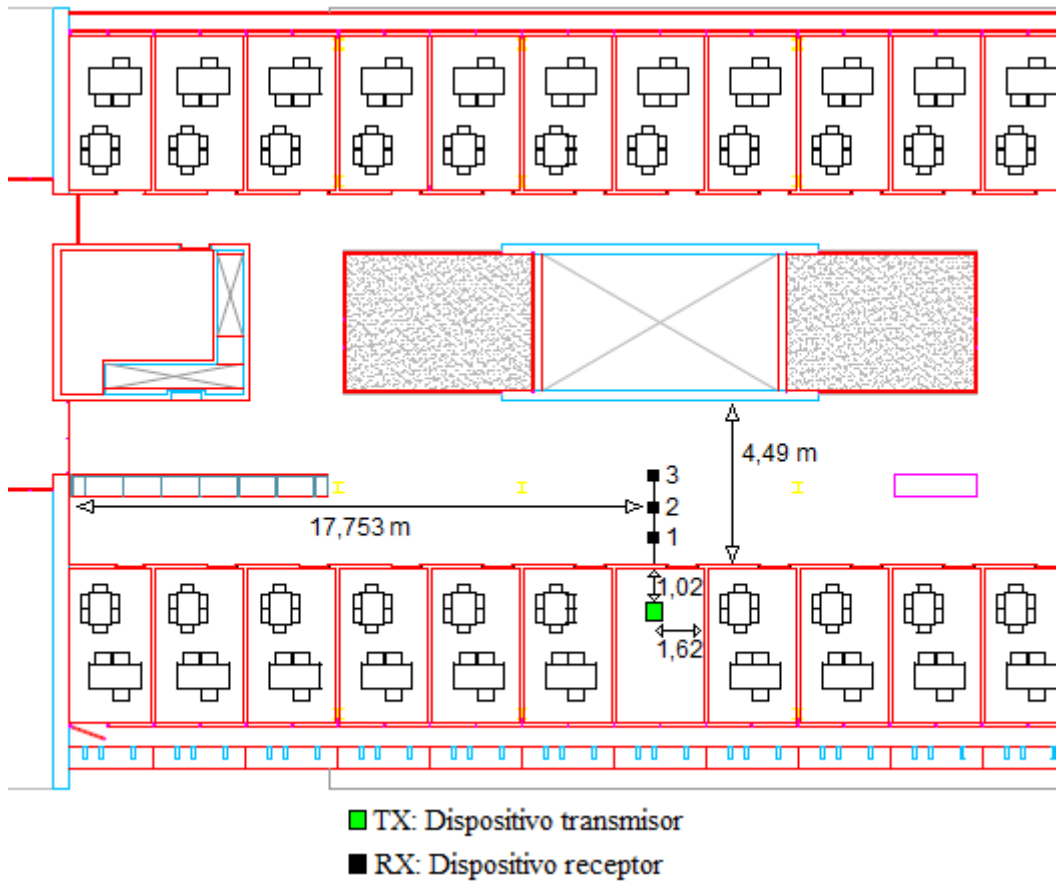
Plano detallado de la posición de los dispositivos en las medidas con la puerta cerrada y el muro del despacho de por medio.
